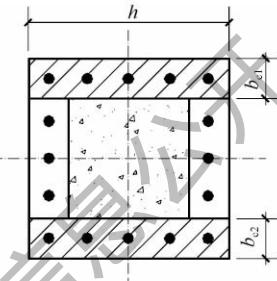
型钢混凝土柱非埋入式柱脚受剪承载力的计算参数示意
